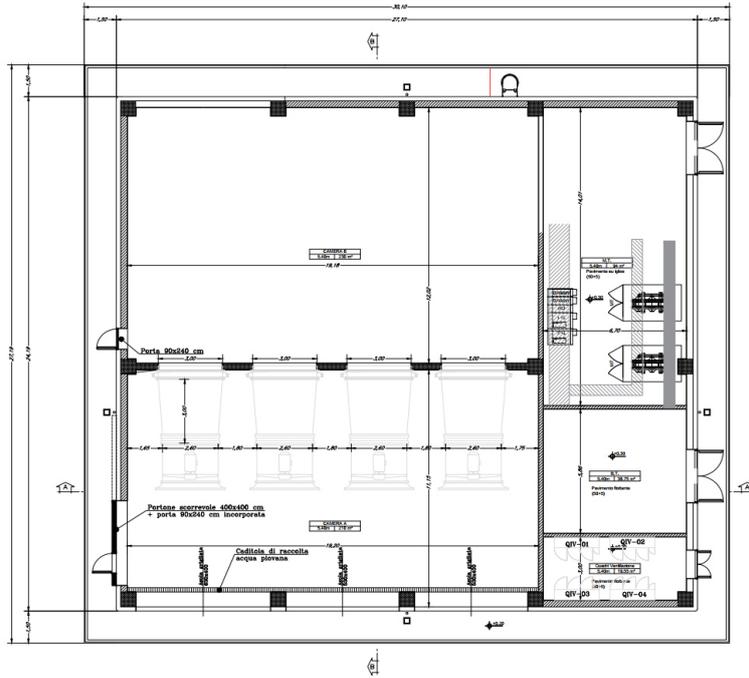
Pianta piano terra fabbricato CVE (FA-G)
